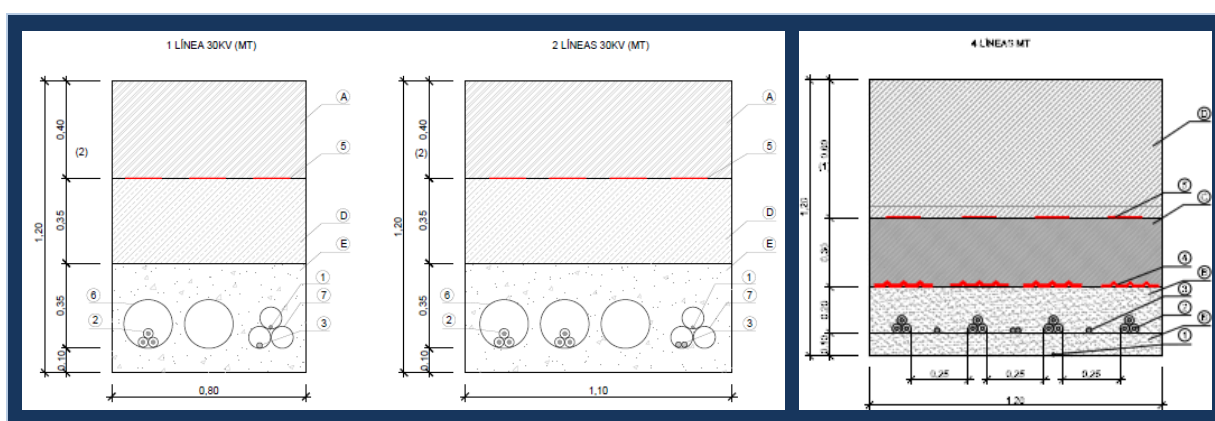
Detalle Sección Zanja. Tipo cruce vial
